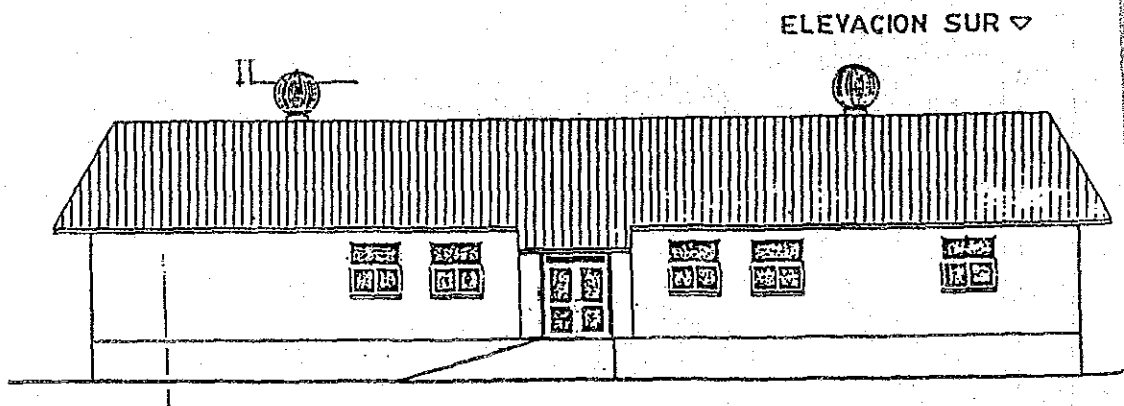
Elevación Sur de Banco Activo de La Platina
